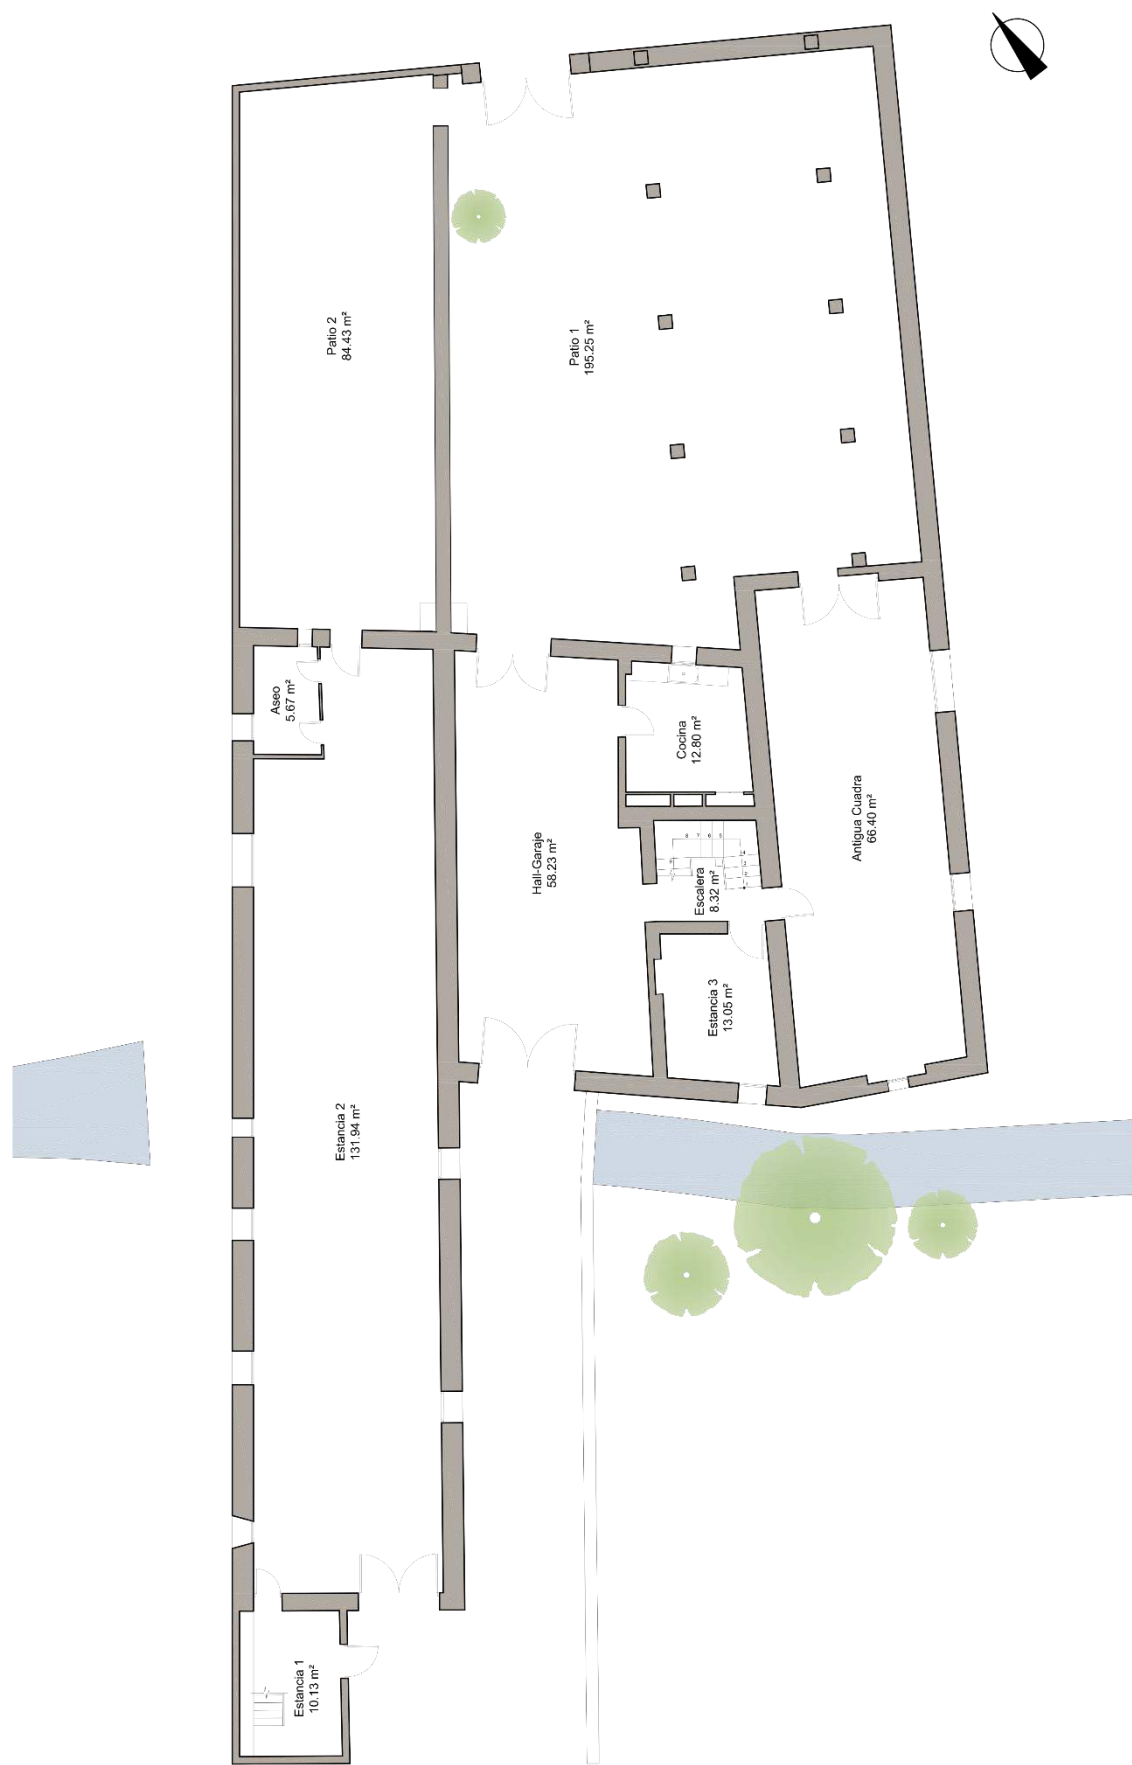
Plano de Planta Baja. Alquería de Farinós. 2015.
